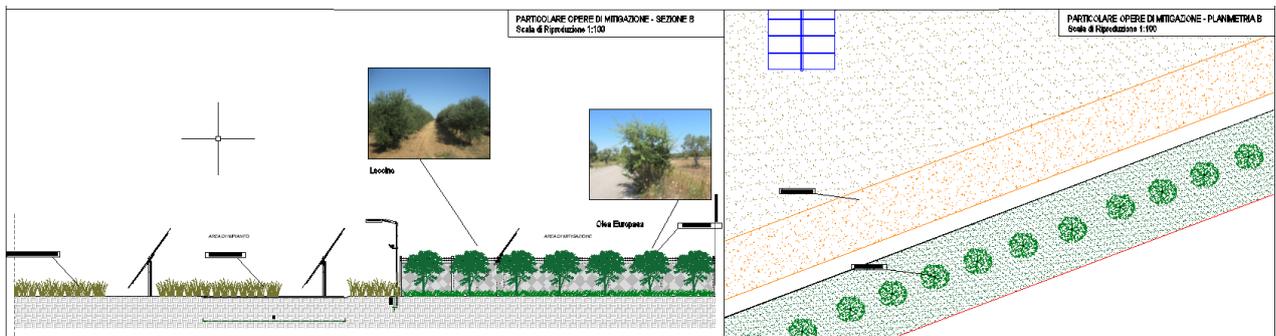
Opere di Mitigazione (Vista in Pianta e Sezione)
